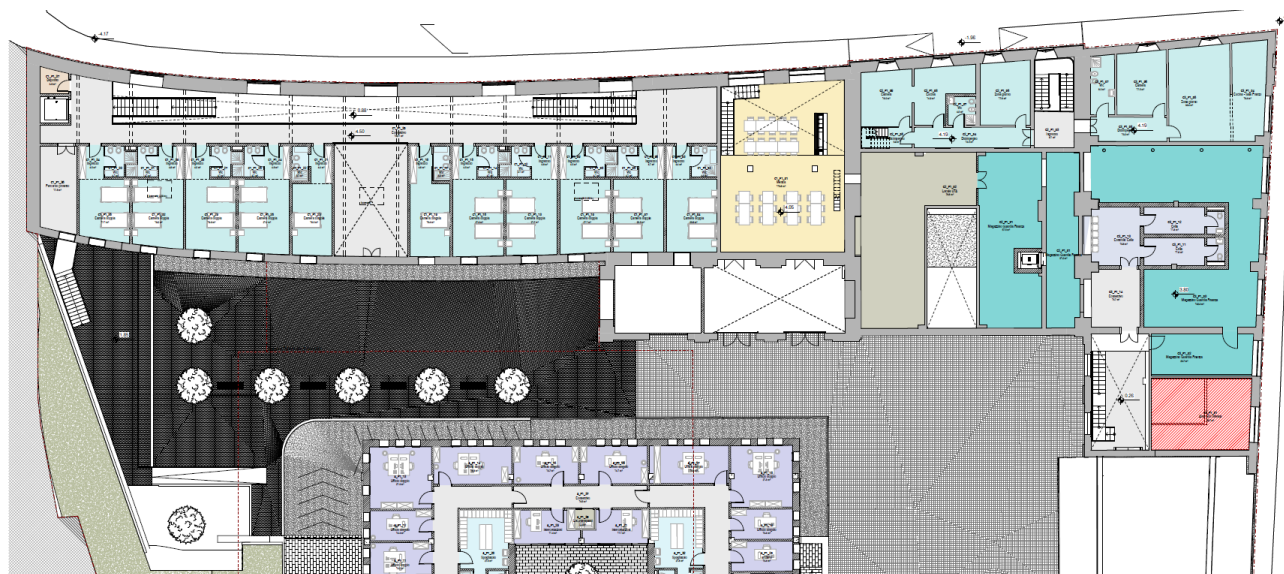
pianta piano primo – estratto della pianta con le indicazioni funzionali
